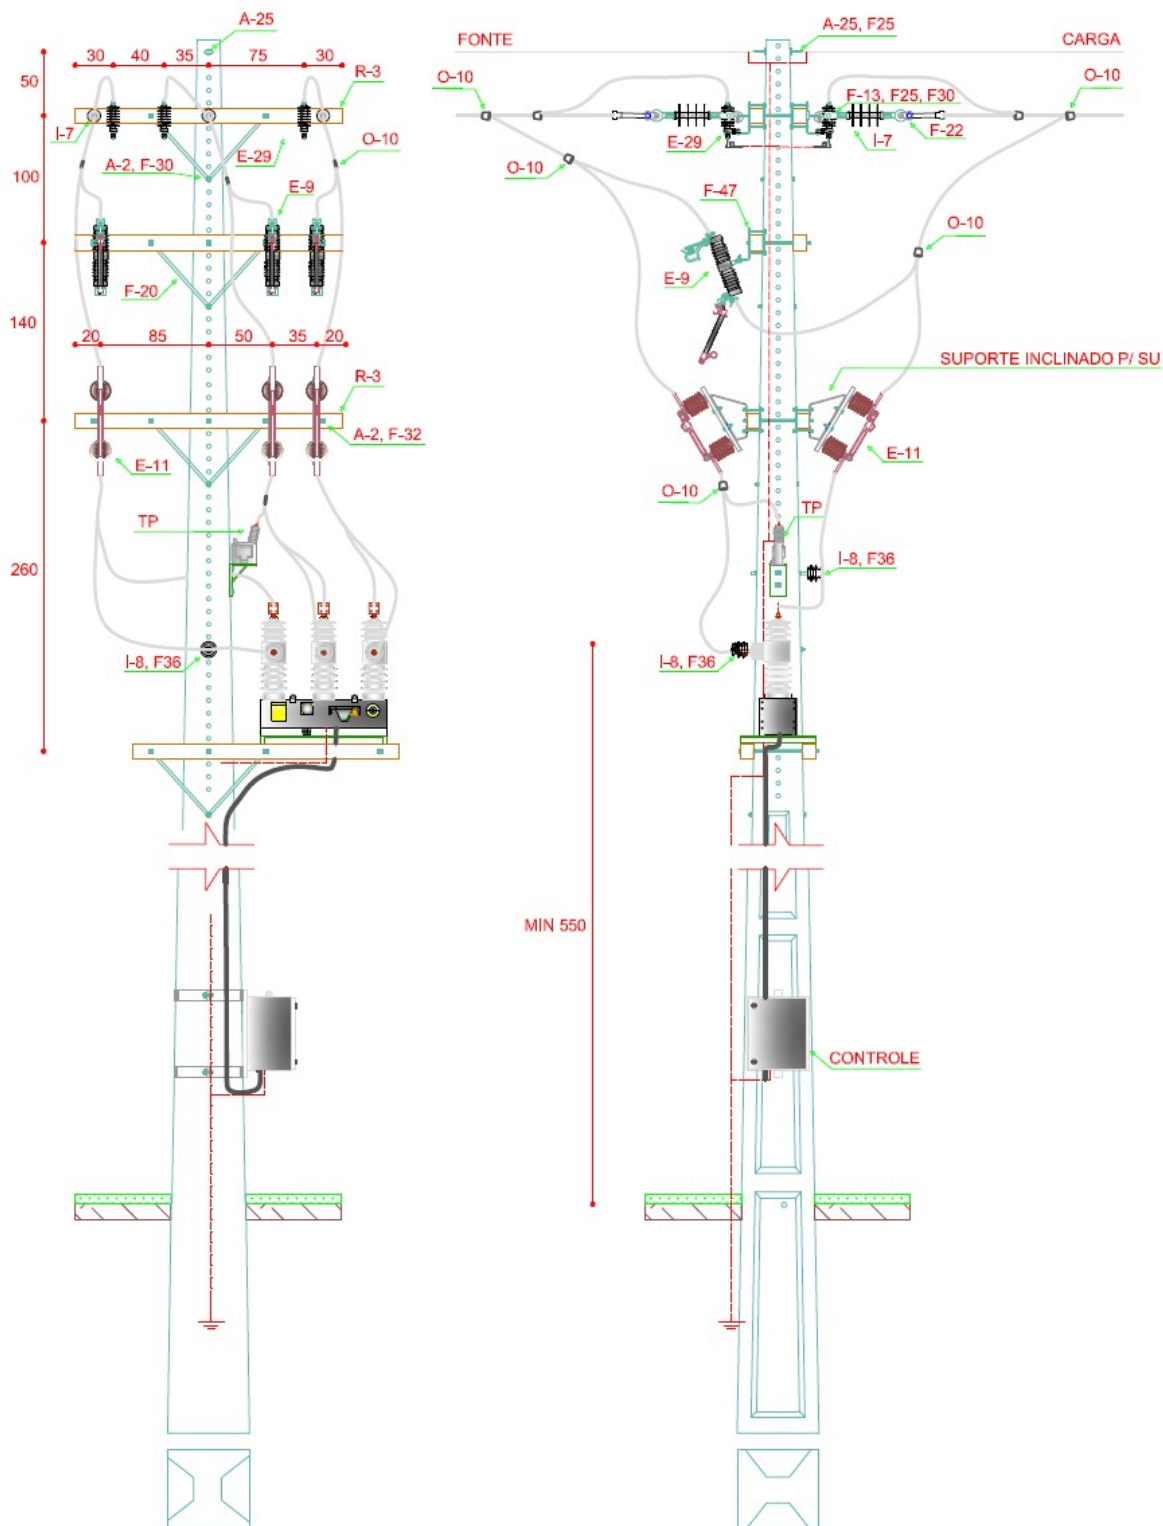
Religador Automático – Vista Frontal e Vista Lateral
